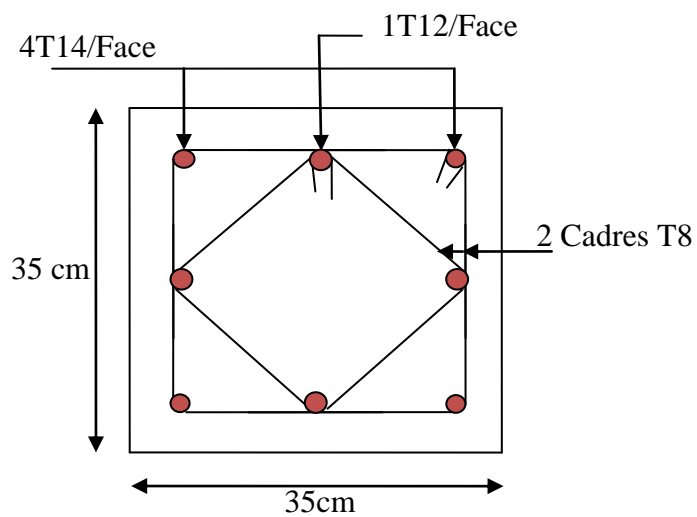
Schéma de ferrailage des poteaux de Buanderie
